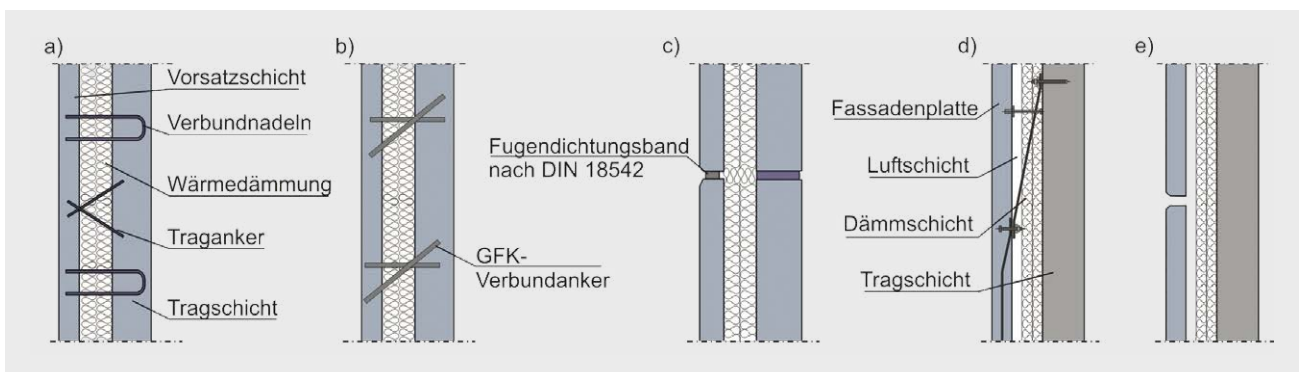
Prinzipielle Fassadenausbildungen und typische Fugendetails, a), b) und c) Sandwichelemente, d) und e) vorgehängte Fassadenplatten
